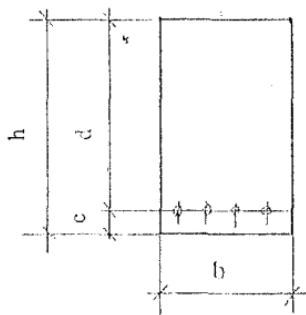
К расчету изгибающего элемента с одиночной арматурой
